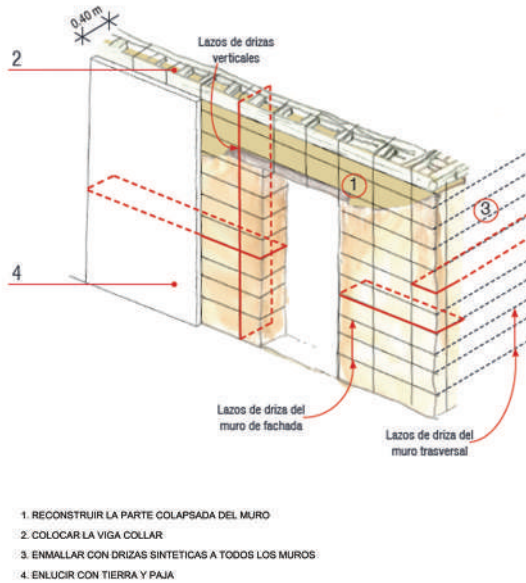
Refuerzos: viga collar y lazos verticales y horizontales de driza. Fuente: Julio Vargas, 2014.
